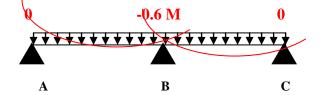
Diagramme des moments des appuis pour une poutre à 2 travées
